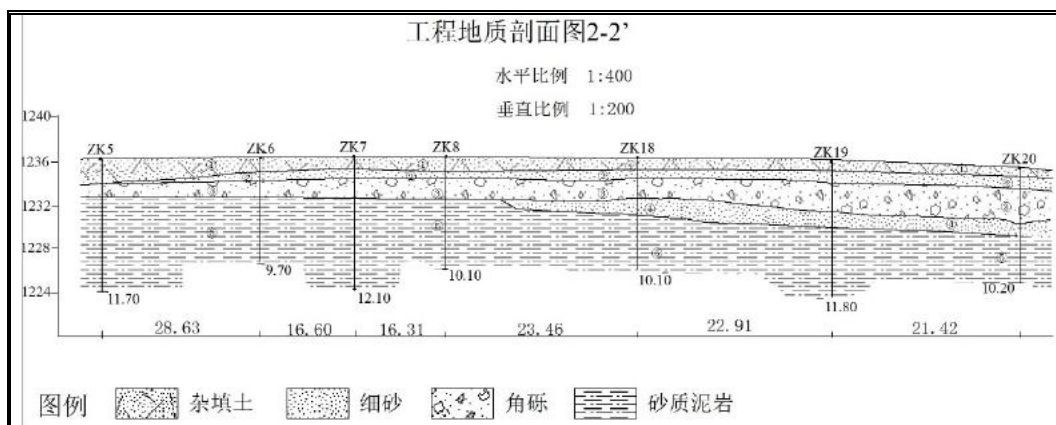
厂区典型剖面 2-2'地质剖面图
